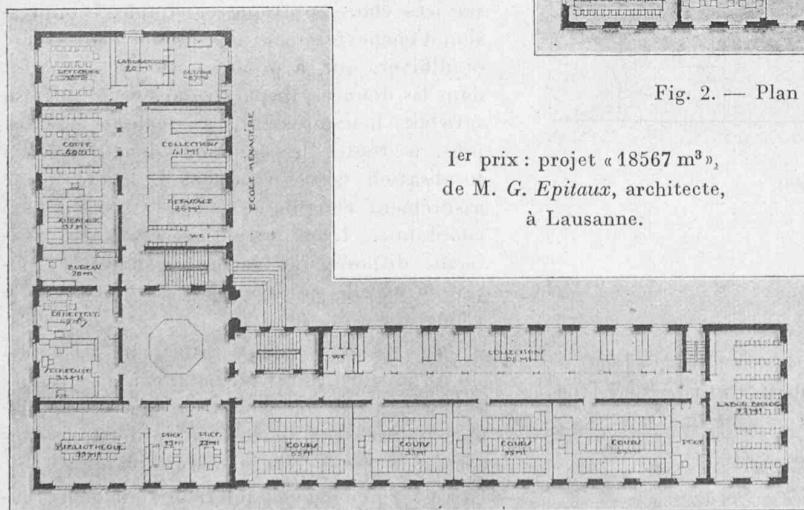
Plan du rez-de-chaussée supérieur. — 1 : 600.
